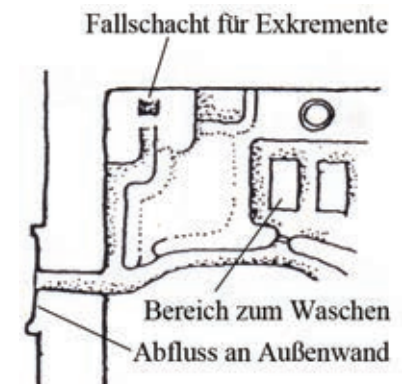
Grundriss eines typischen einfachen Badezimmers.
